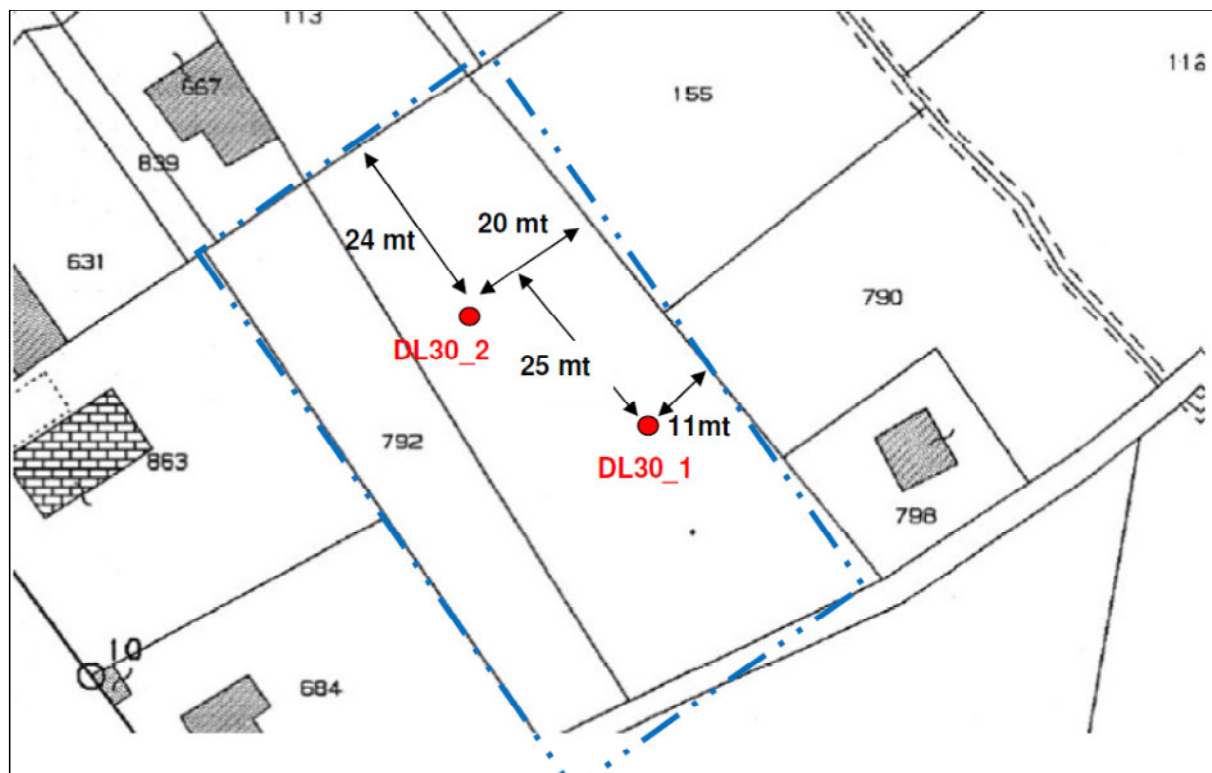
Planimetria con ubicazione delle prove DL30 su stralcio catastale
